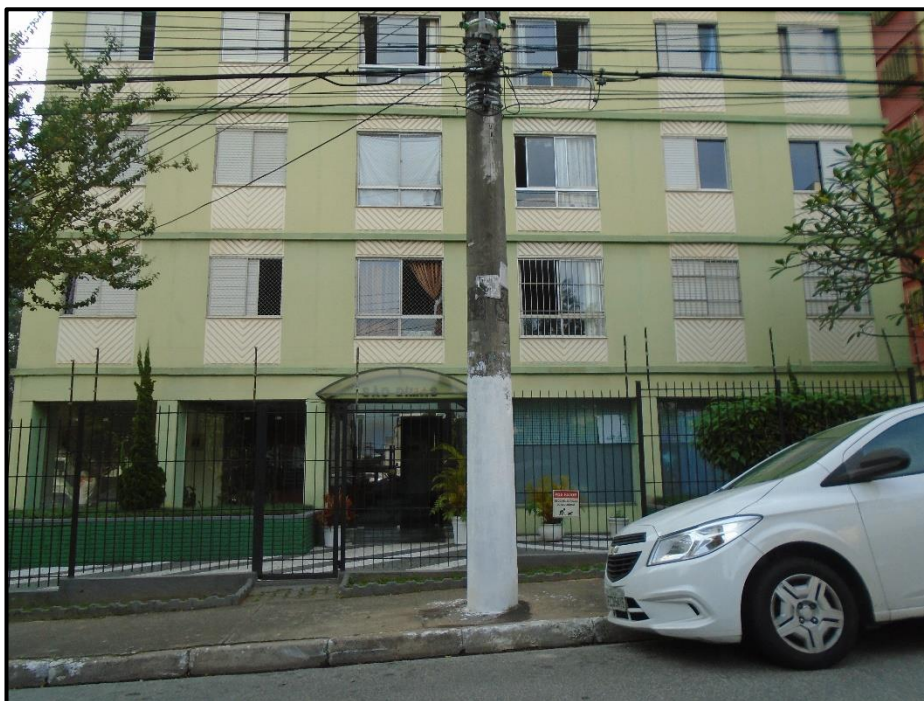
SISTEMA CONSTRUTIVO SEMELHANTE RESIDENCIAL EM ESTUDO.
